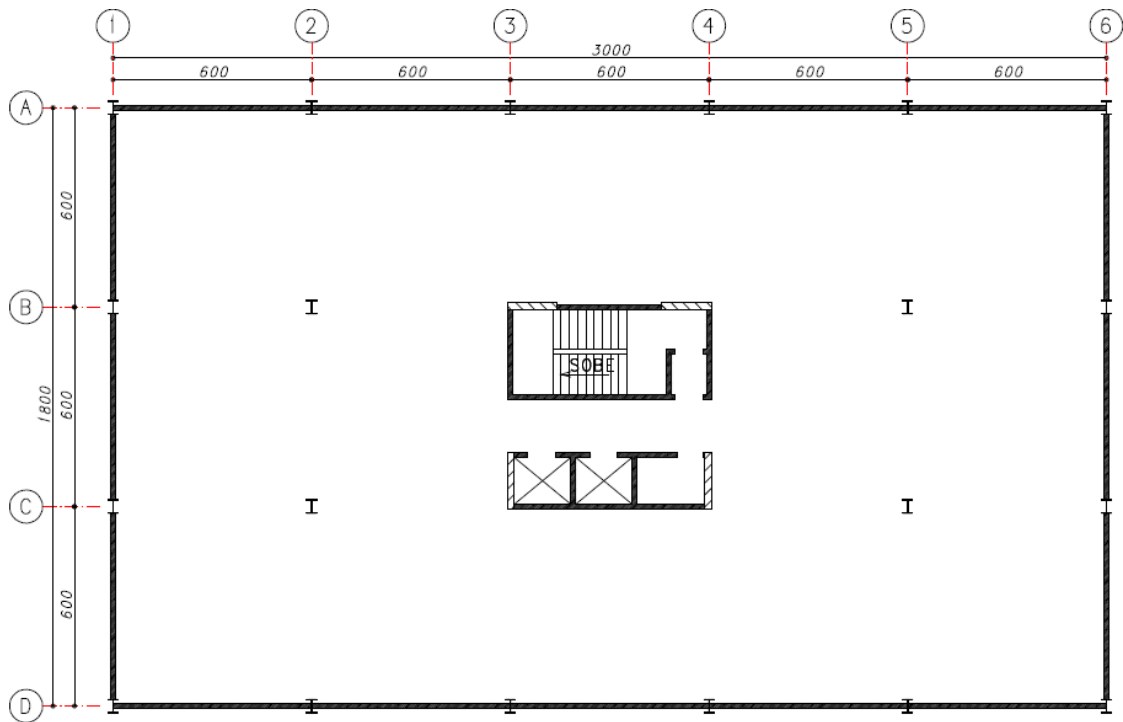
Pavimento tipo – Planta baixa (adaptado de [1])
